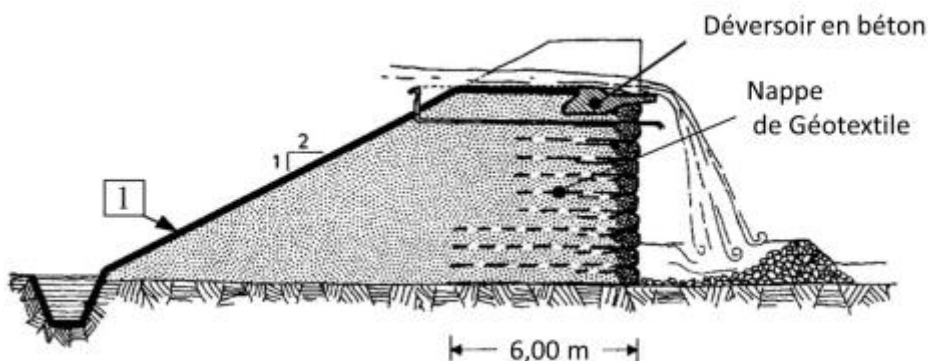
Coupe transversal du barrage de Maraval avec son parement aval renforcé.
